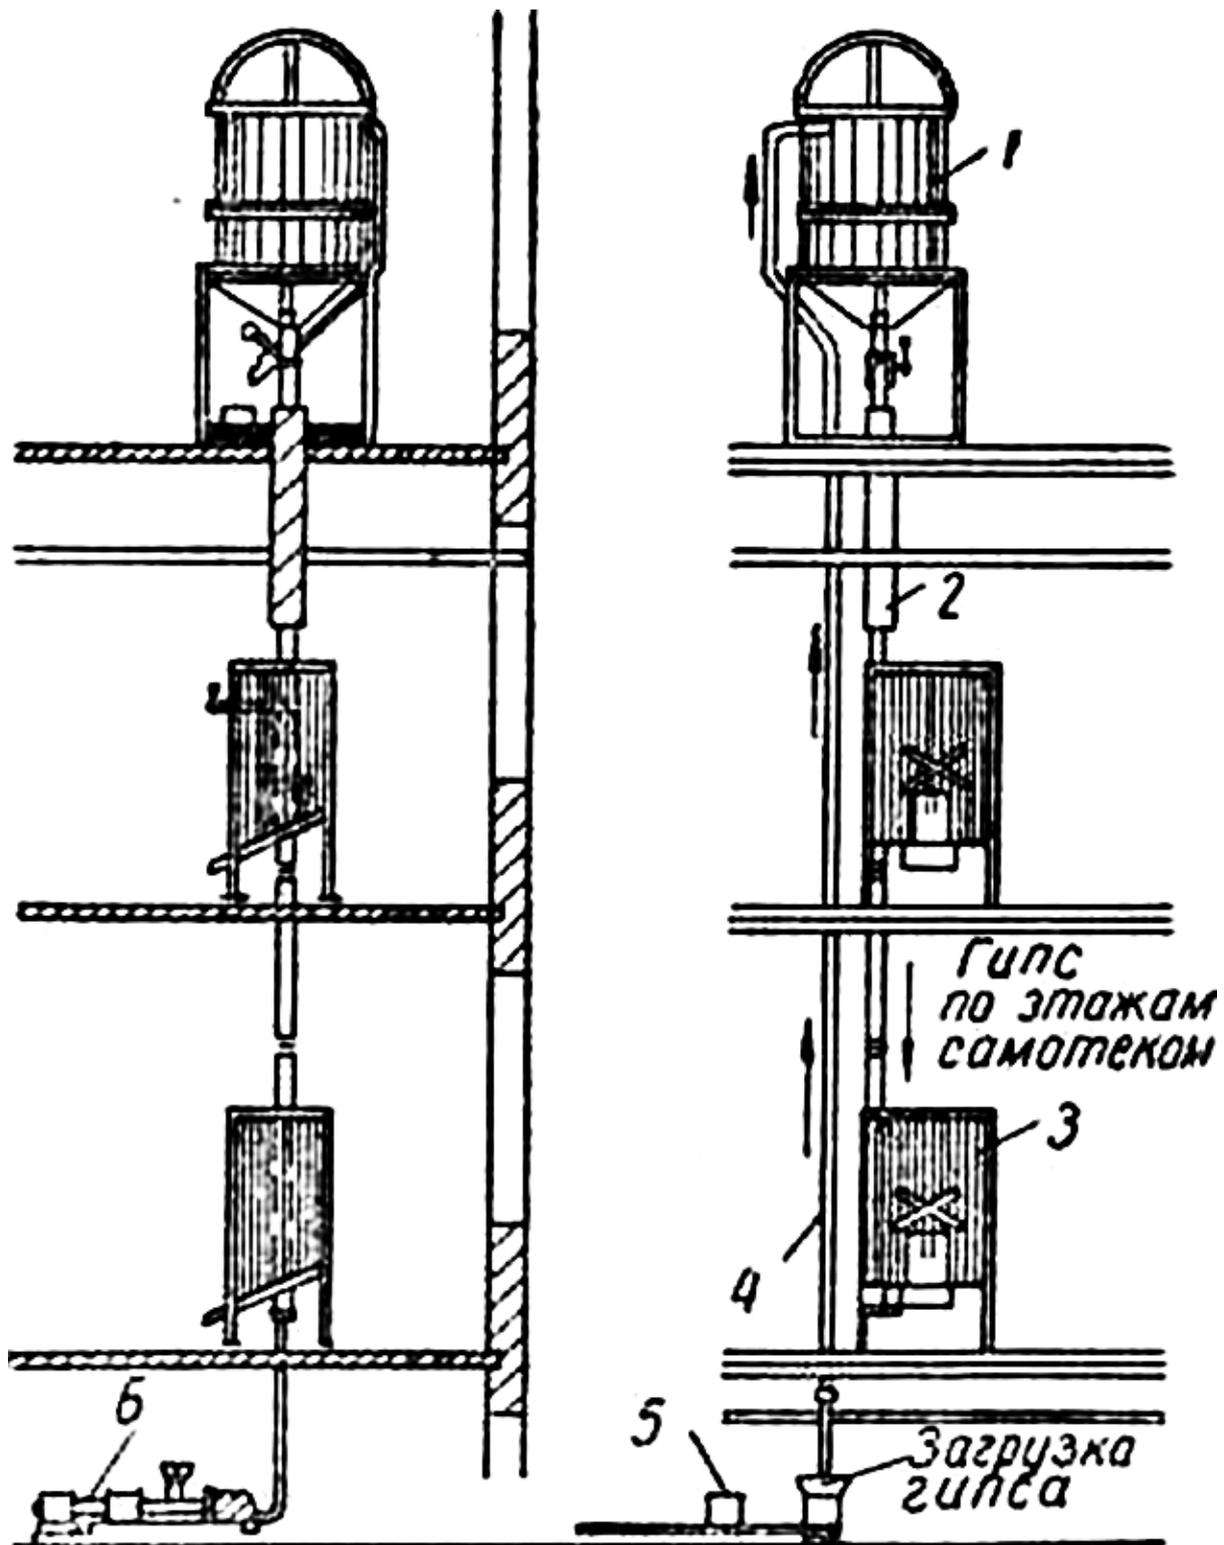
Схема пневматического транспорта пылевидных вязущих материалов по этажам здания: 1 – приемный бункер-циклон; 2 – стояк для раздачи гипса по этажам; 3 – поэтажный бункер для гипса; 4 – металлический стояк для подачи алебастро-воздушной смеси в приемный бункер-циклон; 5 – маслораспределитель; 6 – винтовой питатель
